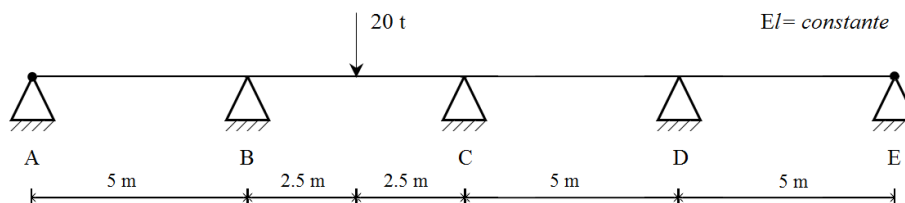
Viga continua de 20 m con una carga aplicada de 20 t.
